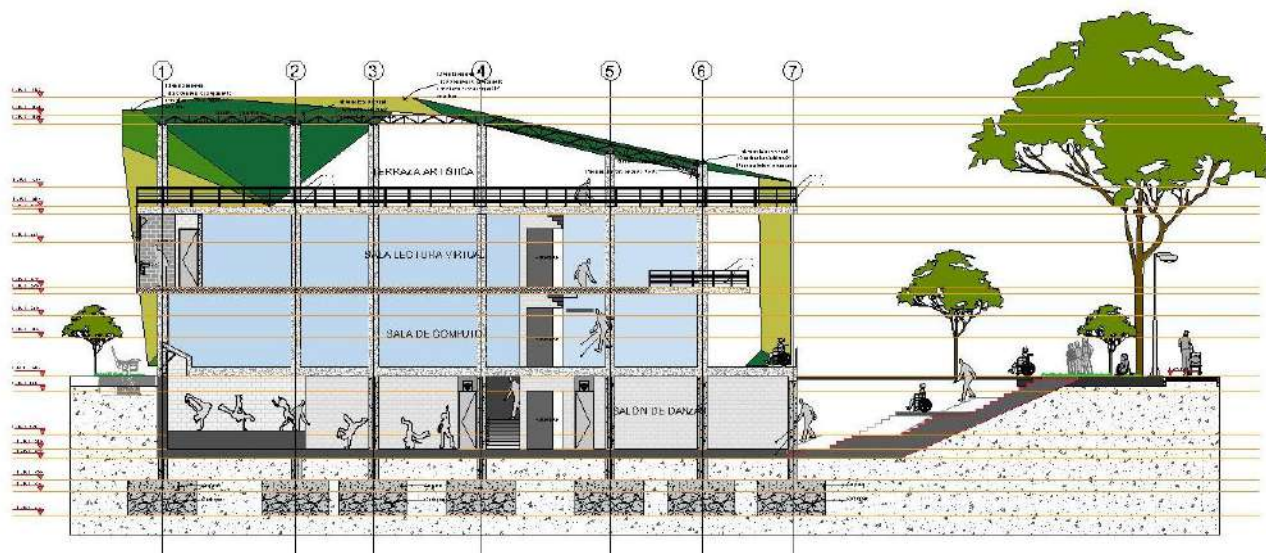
Sección arquitectónica, transversal, edificio lúdico. Fuente: Elaboración propia 2021.
